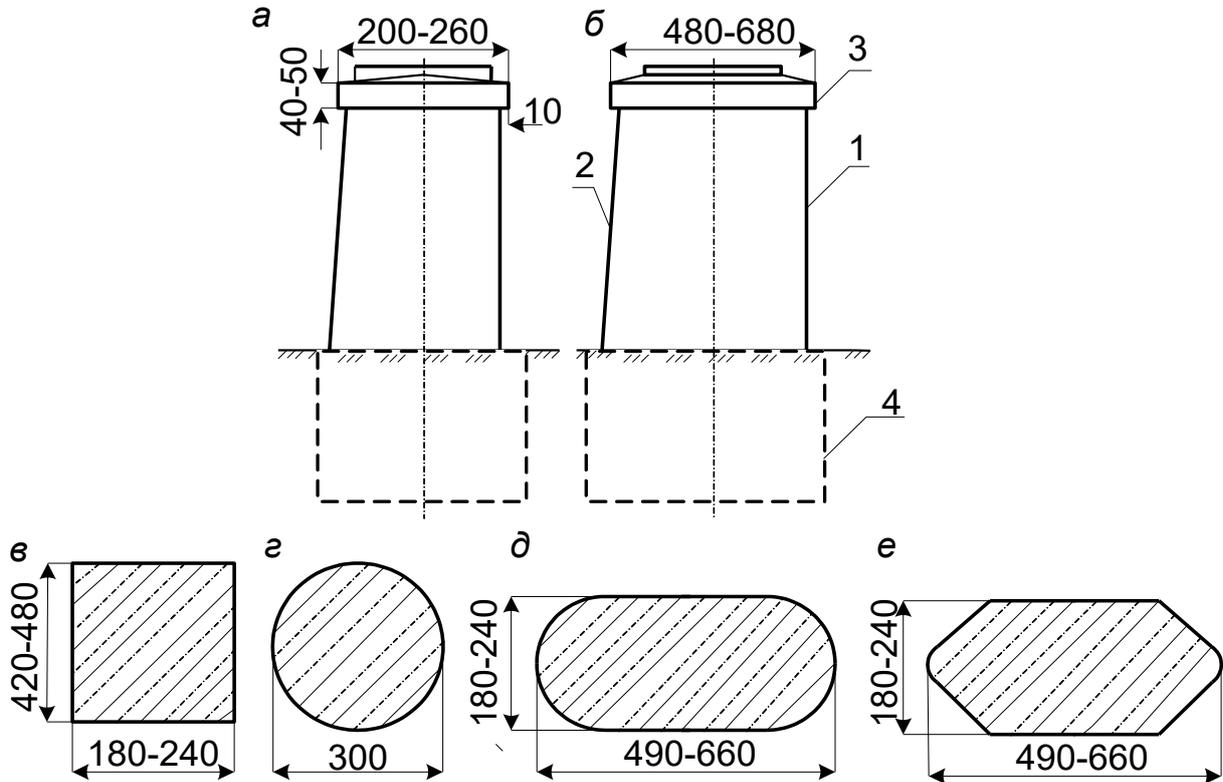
Массивная монолитная промежуточная опора: а – вид вдоль оси; б –вид поперек оси моста; в, г – прямоугольное, круглое, очертание в плане; д, е – с закруглением и заострением боковых граней в плане; 1 – вертикальная боковая грань тела;
